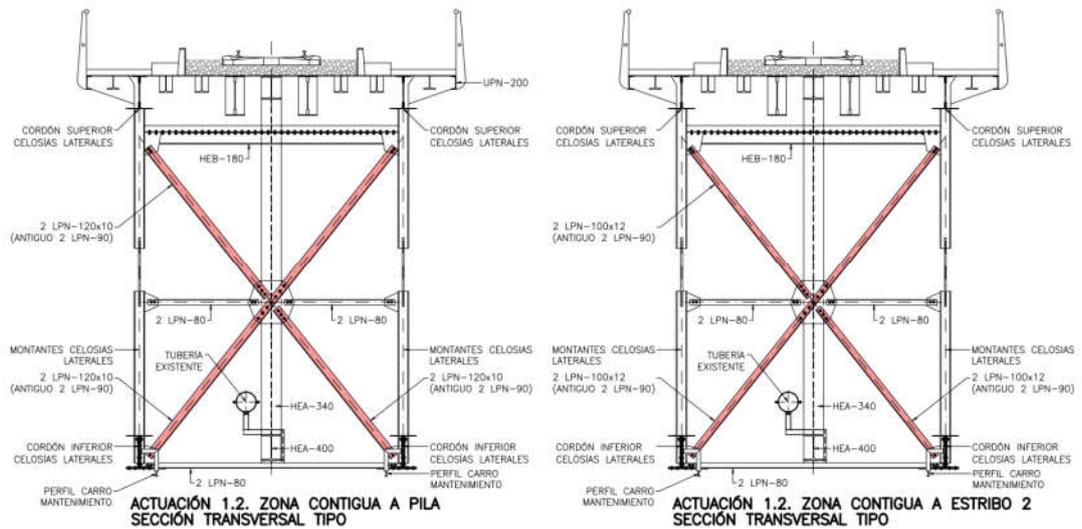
Sustitución de los perfiles del arriostramiento colindante a la pila y estribo 2
